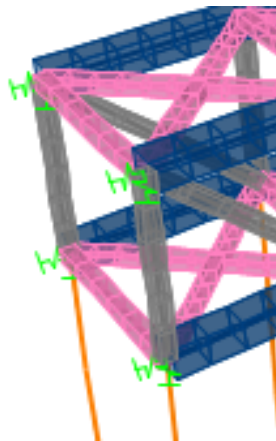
Detalle de los muelles como condición de apoyo.
